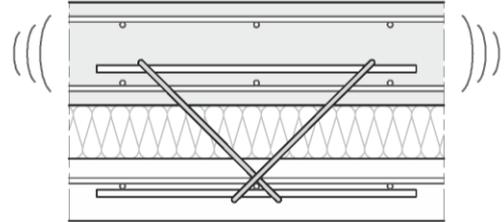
Nachverdichten der oberen Schicht. Nach dem Einbau der Anker und Nadeln ist ein Nachverdichten des Betons erforderlich. Der Abbindeprozess des Betons muss zeitlich berücksichtigt werden.
